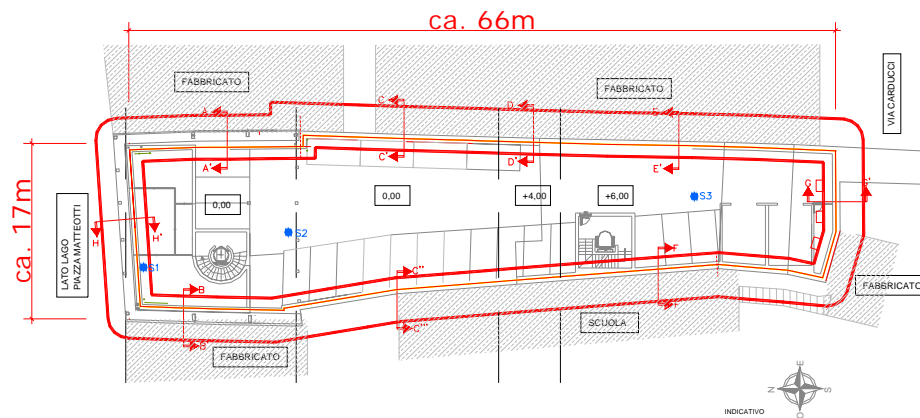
Planimetria schematica dell'intervento realizzato con la tecnica Soilcrete (Keller)
